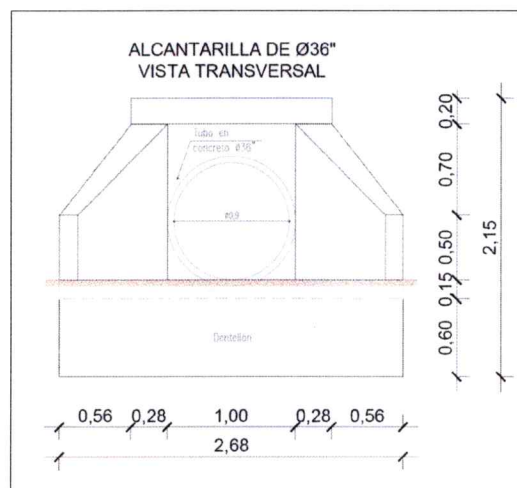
Detalle constructivo\_detalle alcantarilla
